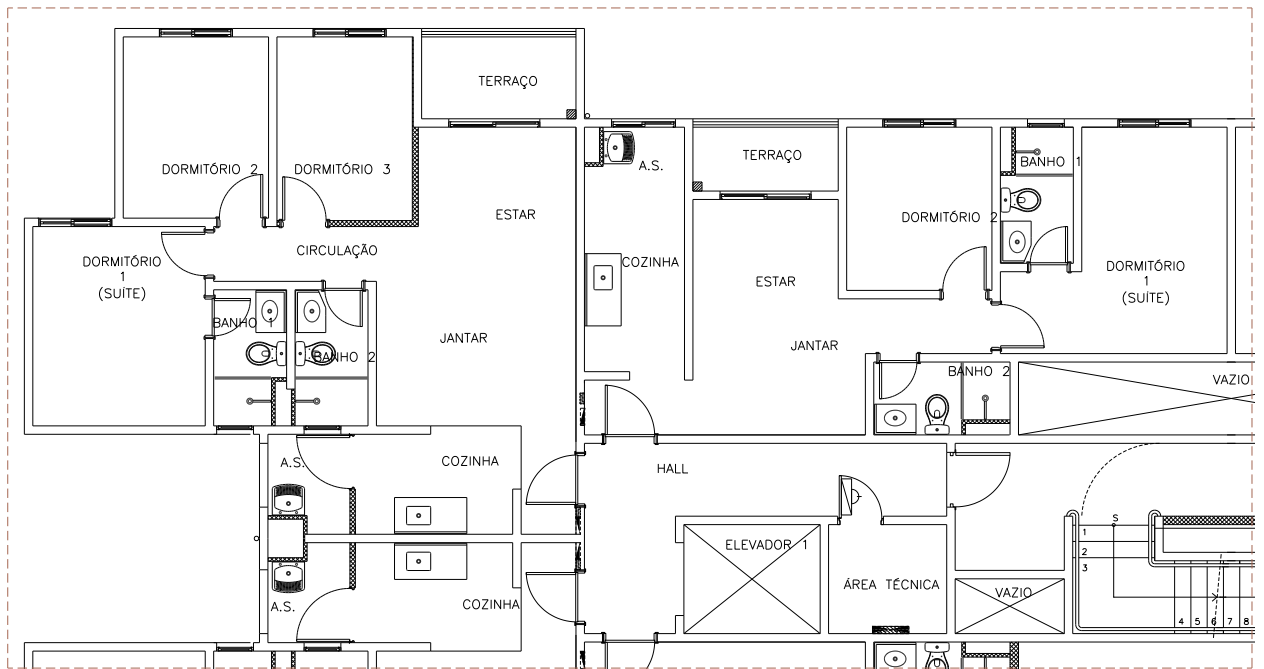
Edifício Way Penha: detalhe da planta arquitetônica
